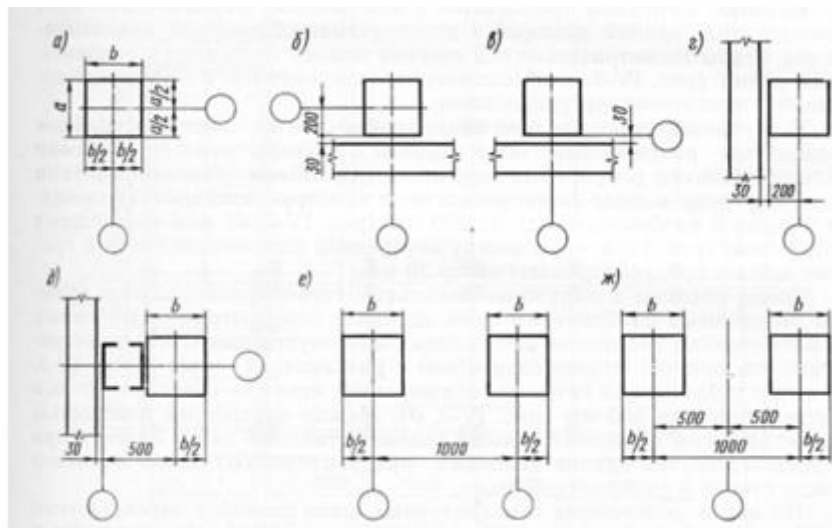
Привязка колонн и стен многоэтажных зданий к разбивочным осям: а — привязка колонн к средним осям; б, в — привязка колонн и стен к крайним продольным осям; г, д — то же, в торцах зданий; е, ж — привязка колонн по линиям поперечных температурных швов
